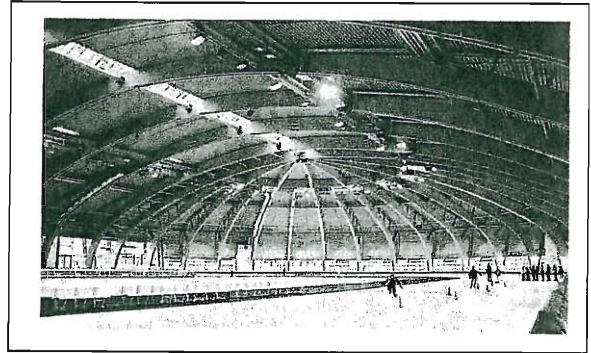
Eisschnelllaufhalle Erfurt, Ausführung: WIEHAG GmbH, Altheim (A), 2001
